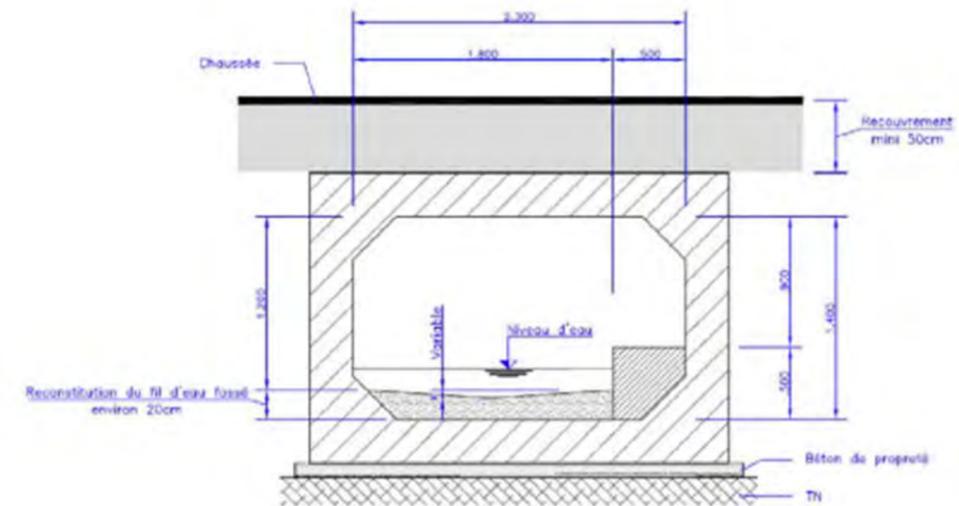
Profil des type des ouvrages mixtes hydraulique – petite faune
